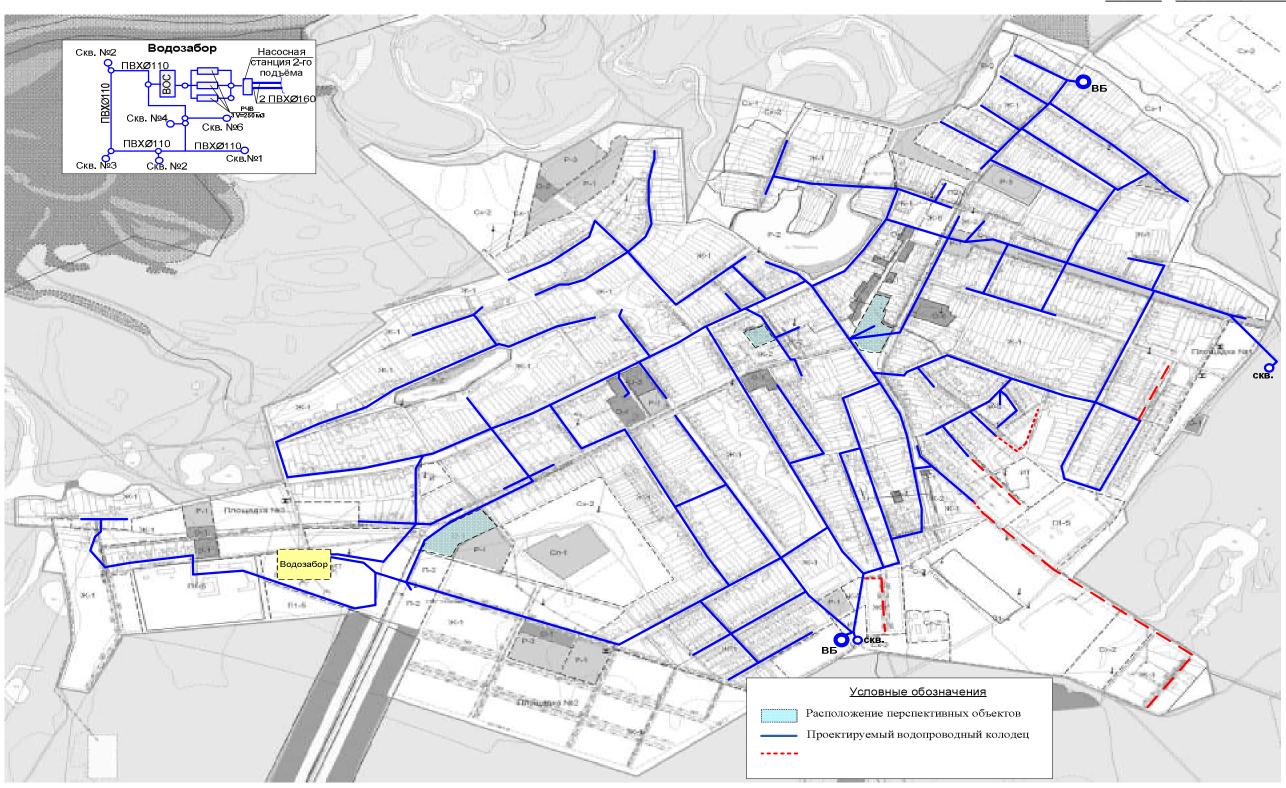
План водопроводных сетей с. Утёвка на первый этап строительства (до 2023 г.)
